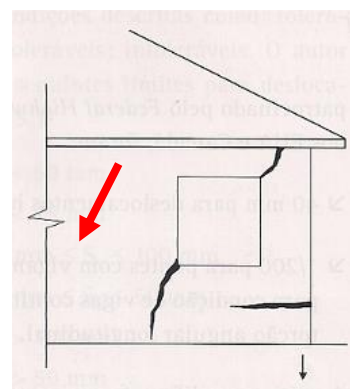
Fissuras em parede portante Com recalque na extremidade
